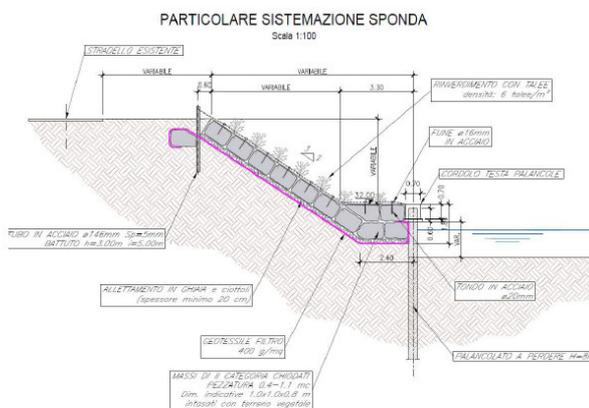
"Sezione della sistemazione di progetto sulla sponda sinistra"
